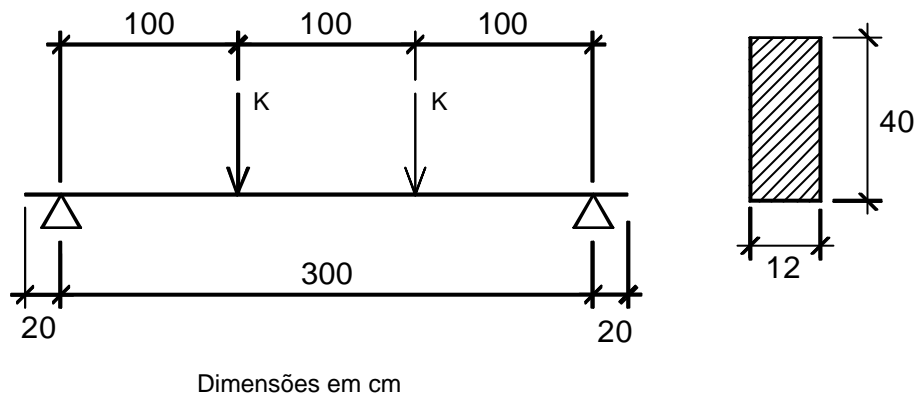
Esquema estrutural da viga do exemplo 2
